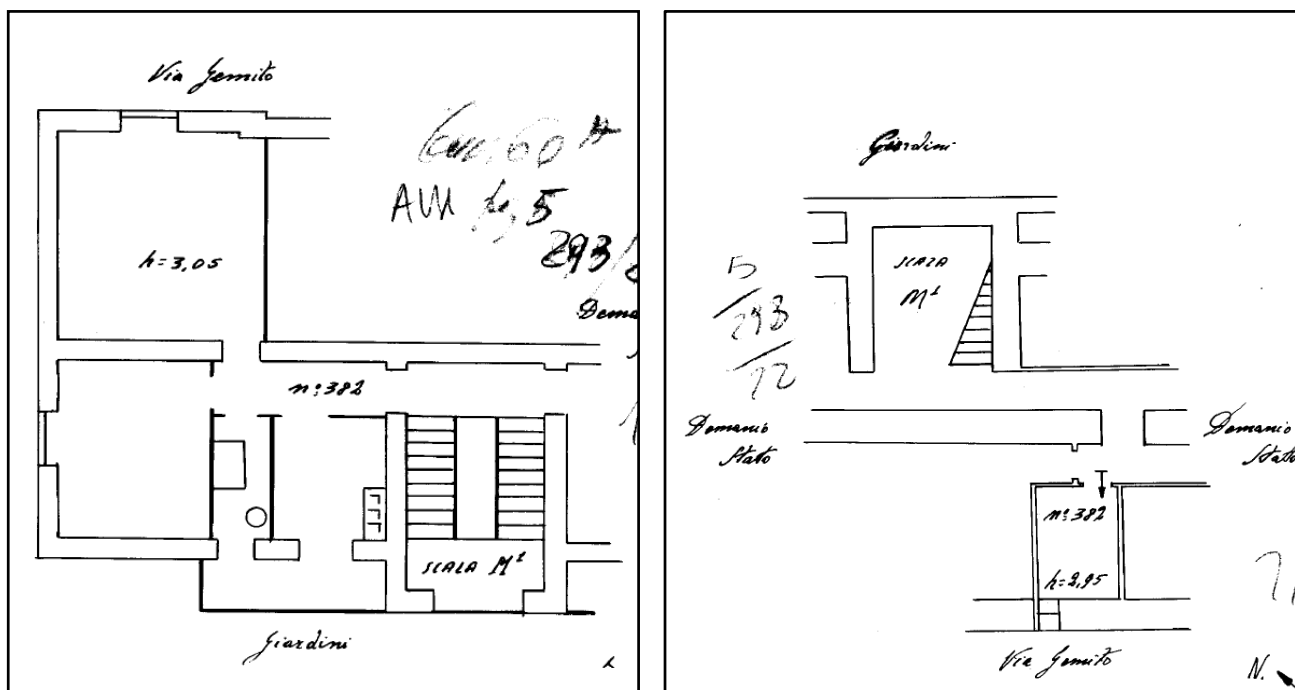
Planimetria catastale sub 22 del 02/05/1952 appartamento e cantina
